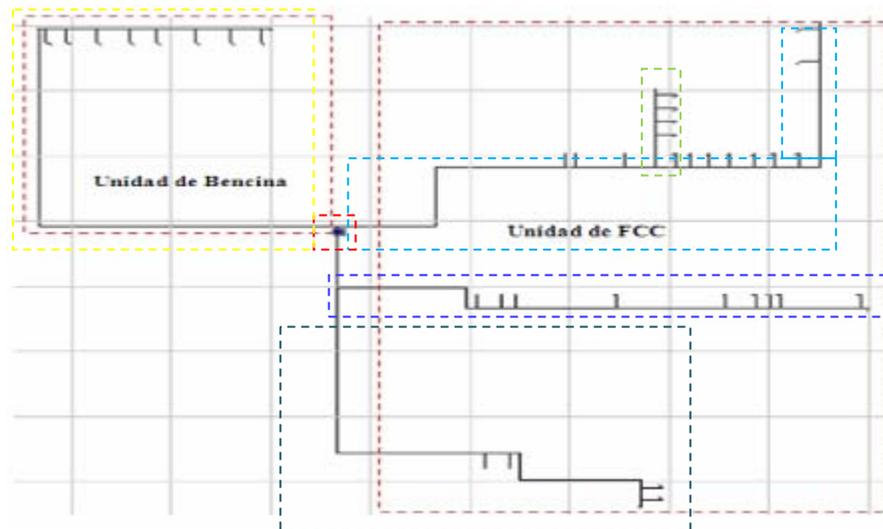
Red de tuberías principal para la Unidad de FCC y Bencina. Vista de planta.
